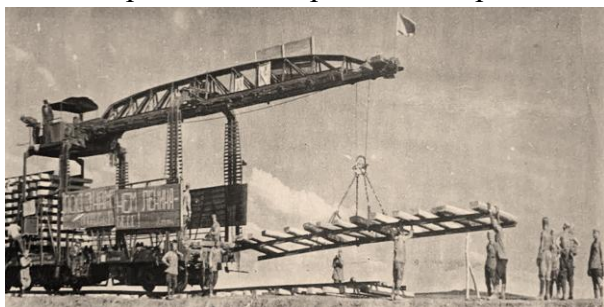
Укладка войсками-железнодорожниками 10-го овждб главного пути на всём протяжении подхода. Разработка каменных карьеров Крымского берега была возложена на 112-й и 114-й военно-строительные отряды Инженерного управления Красной армии. Разработка камня в кубанских карьерах станции Первомайская и станции Баканская производилась силами 3-го внештатного батальона 36-й овждбр.
